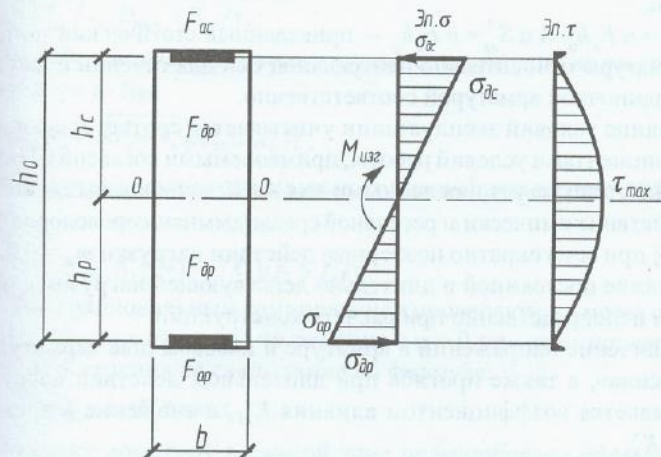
Эпюры нормальных и касательных напряжений изгибаемого элемента с двойным симметричным армированием
